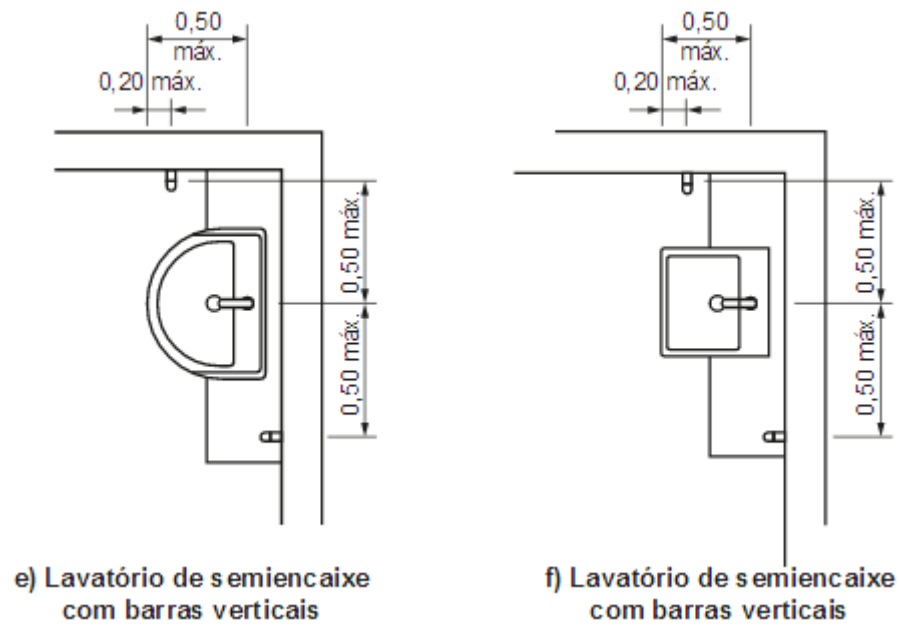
Barra de apoio no lavatório – vista superior (metros)
